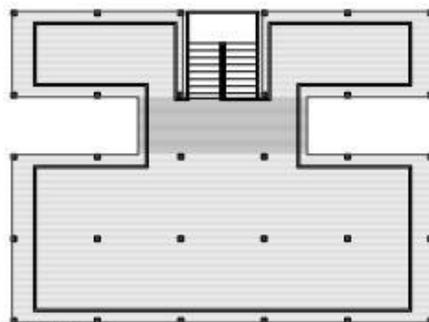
Redesenho das plantas dos pavimentos, projeto Fundação Florestal
